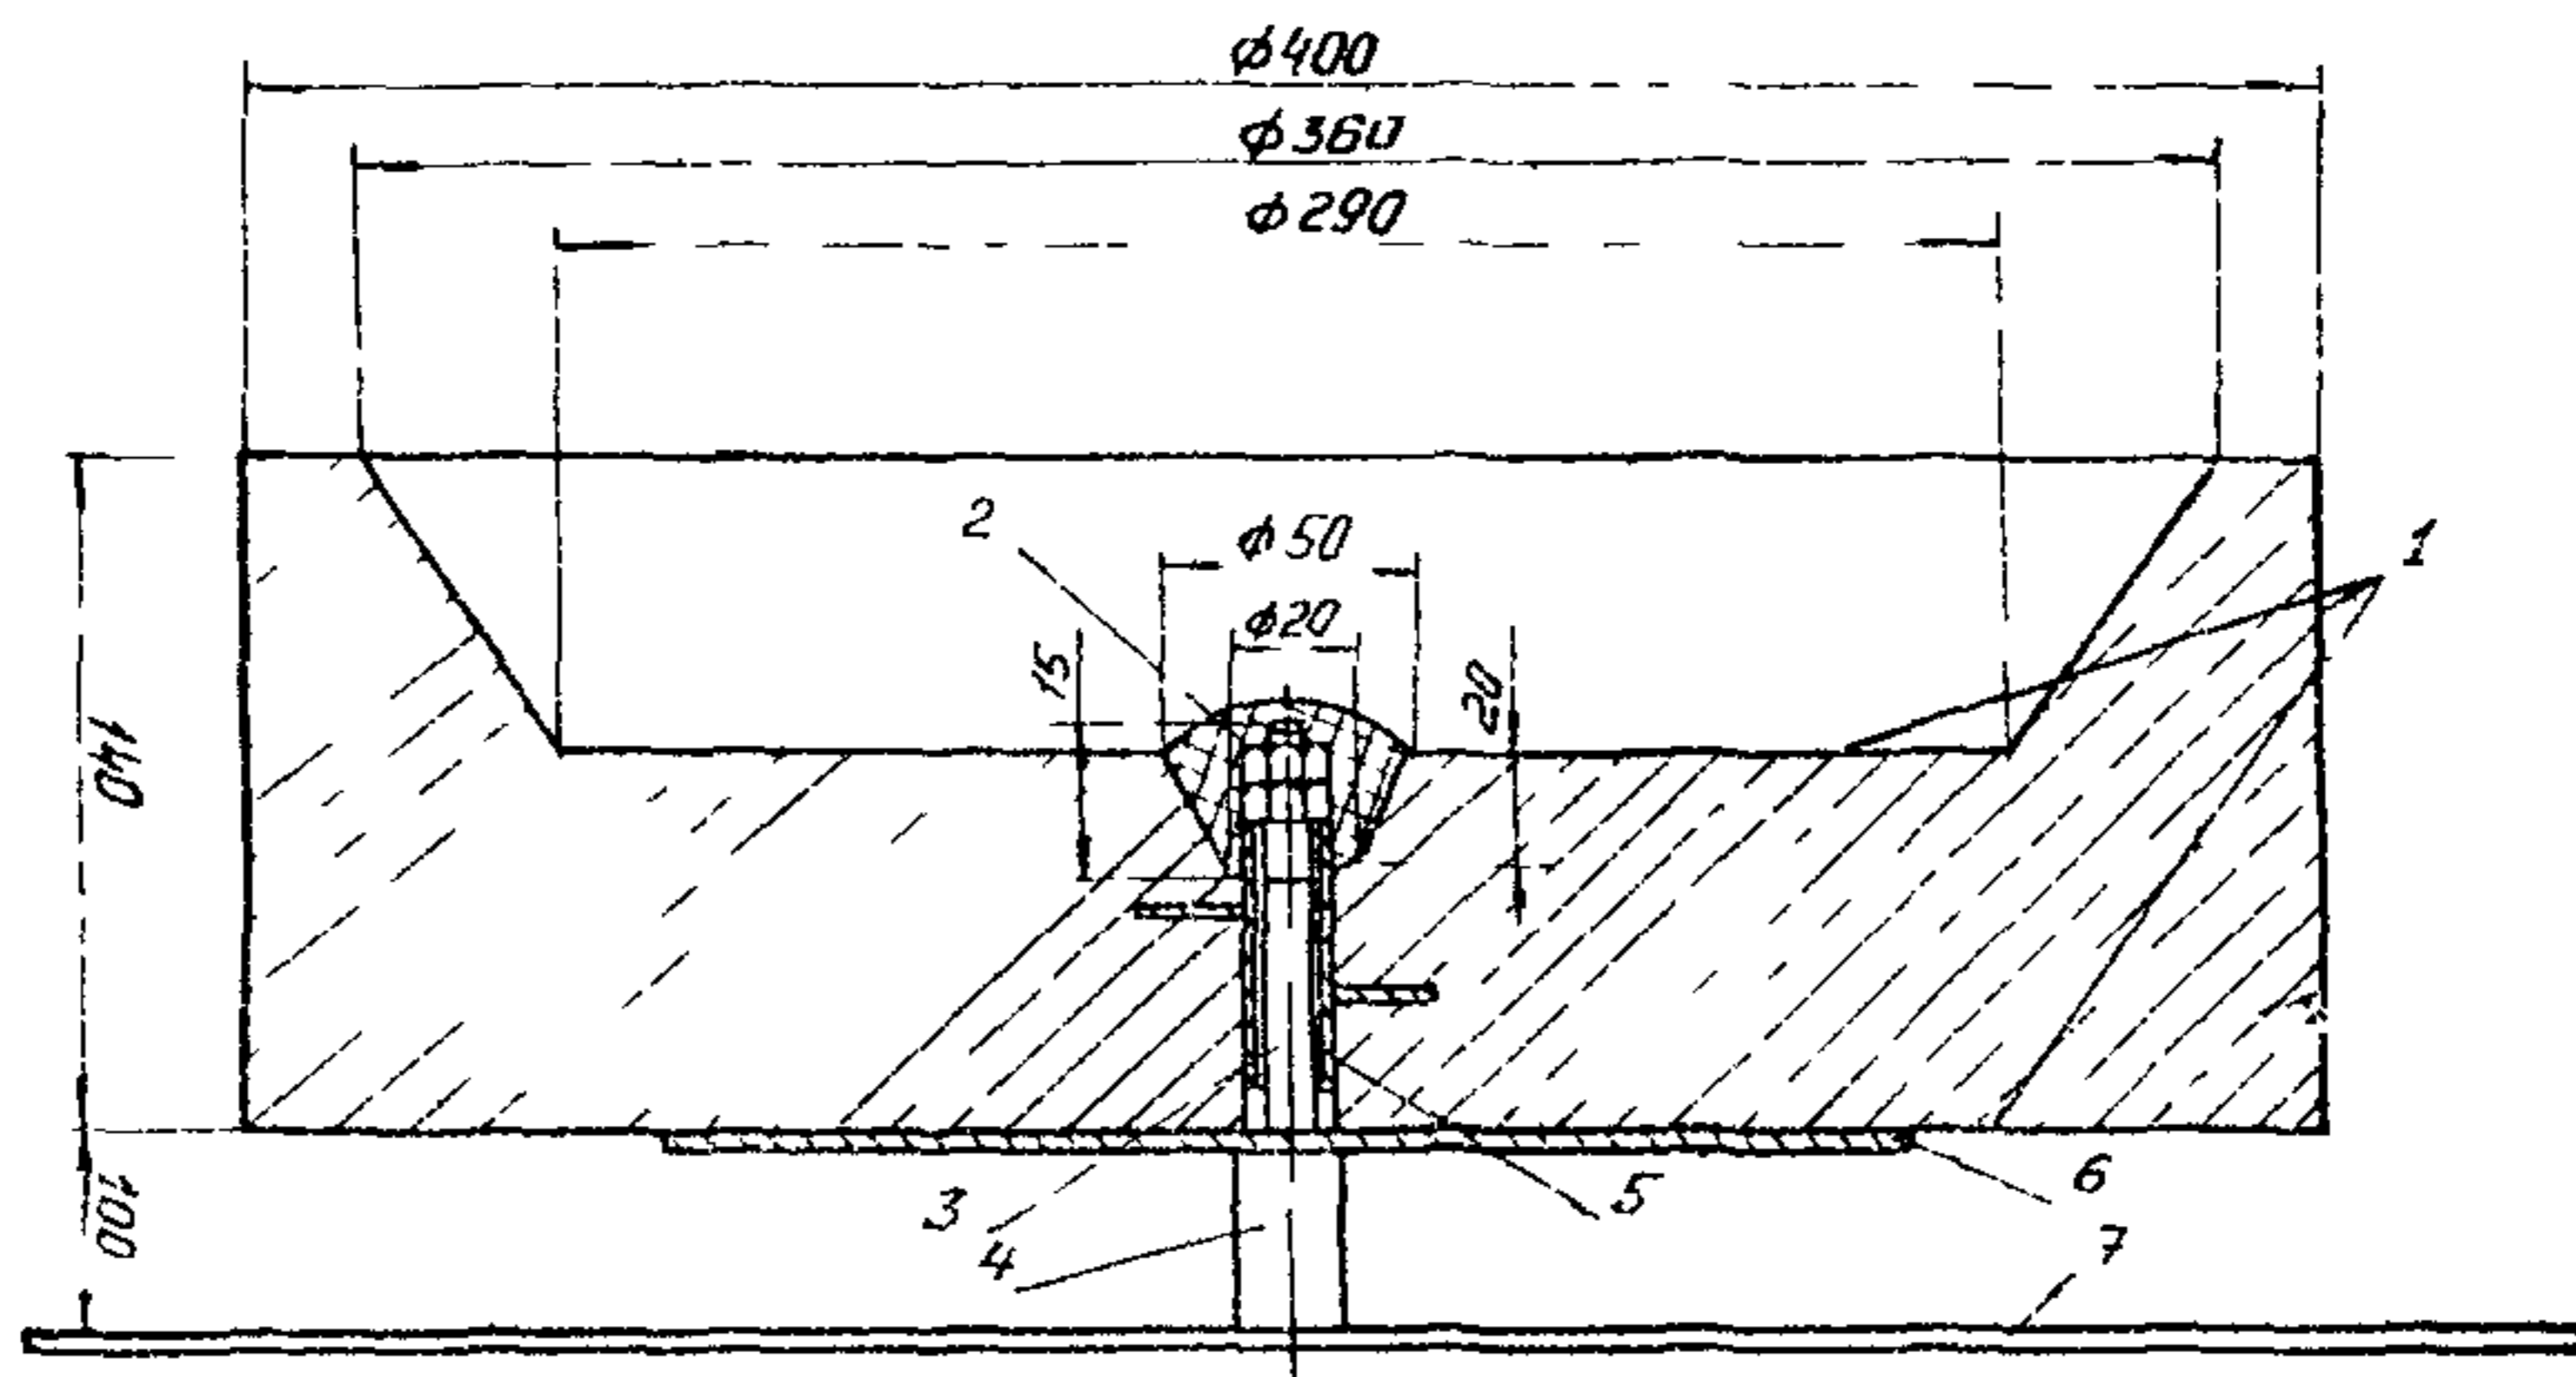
Схема установки протектора ПРМ-20 на днище резервуара:
